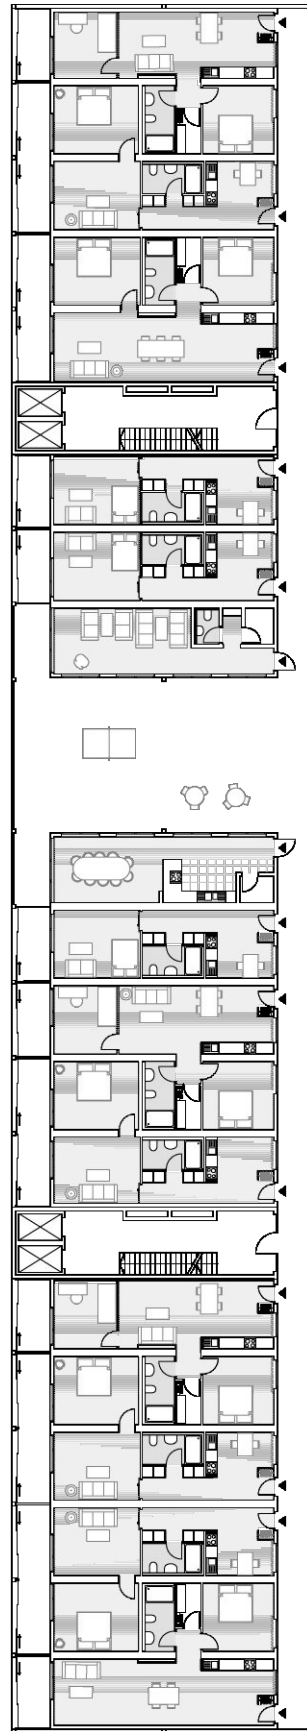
Grundriss 3. Obergeschoss:
